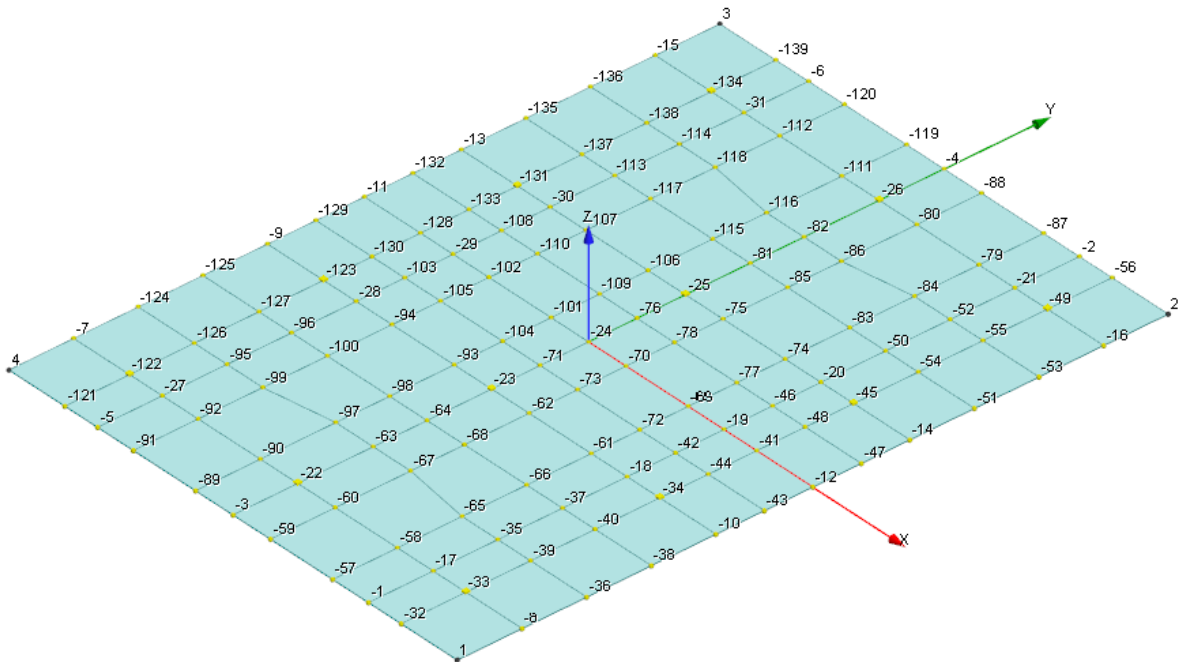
VISTA TRIDIMENSIONALE MODELLO PLINTO PILA CON NUMERO NODI
